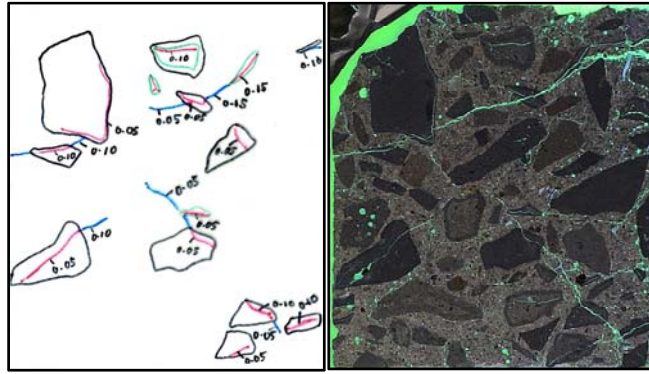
No. 1 内部ひび割れスケッチ図およびブラックライト照射像
